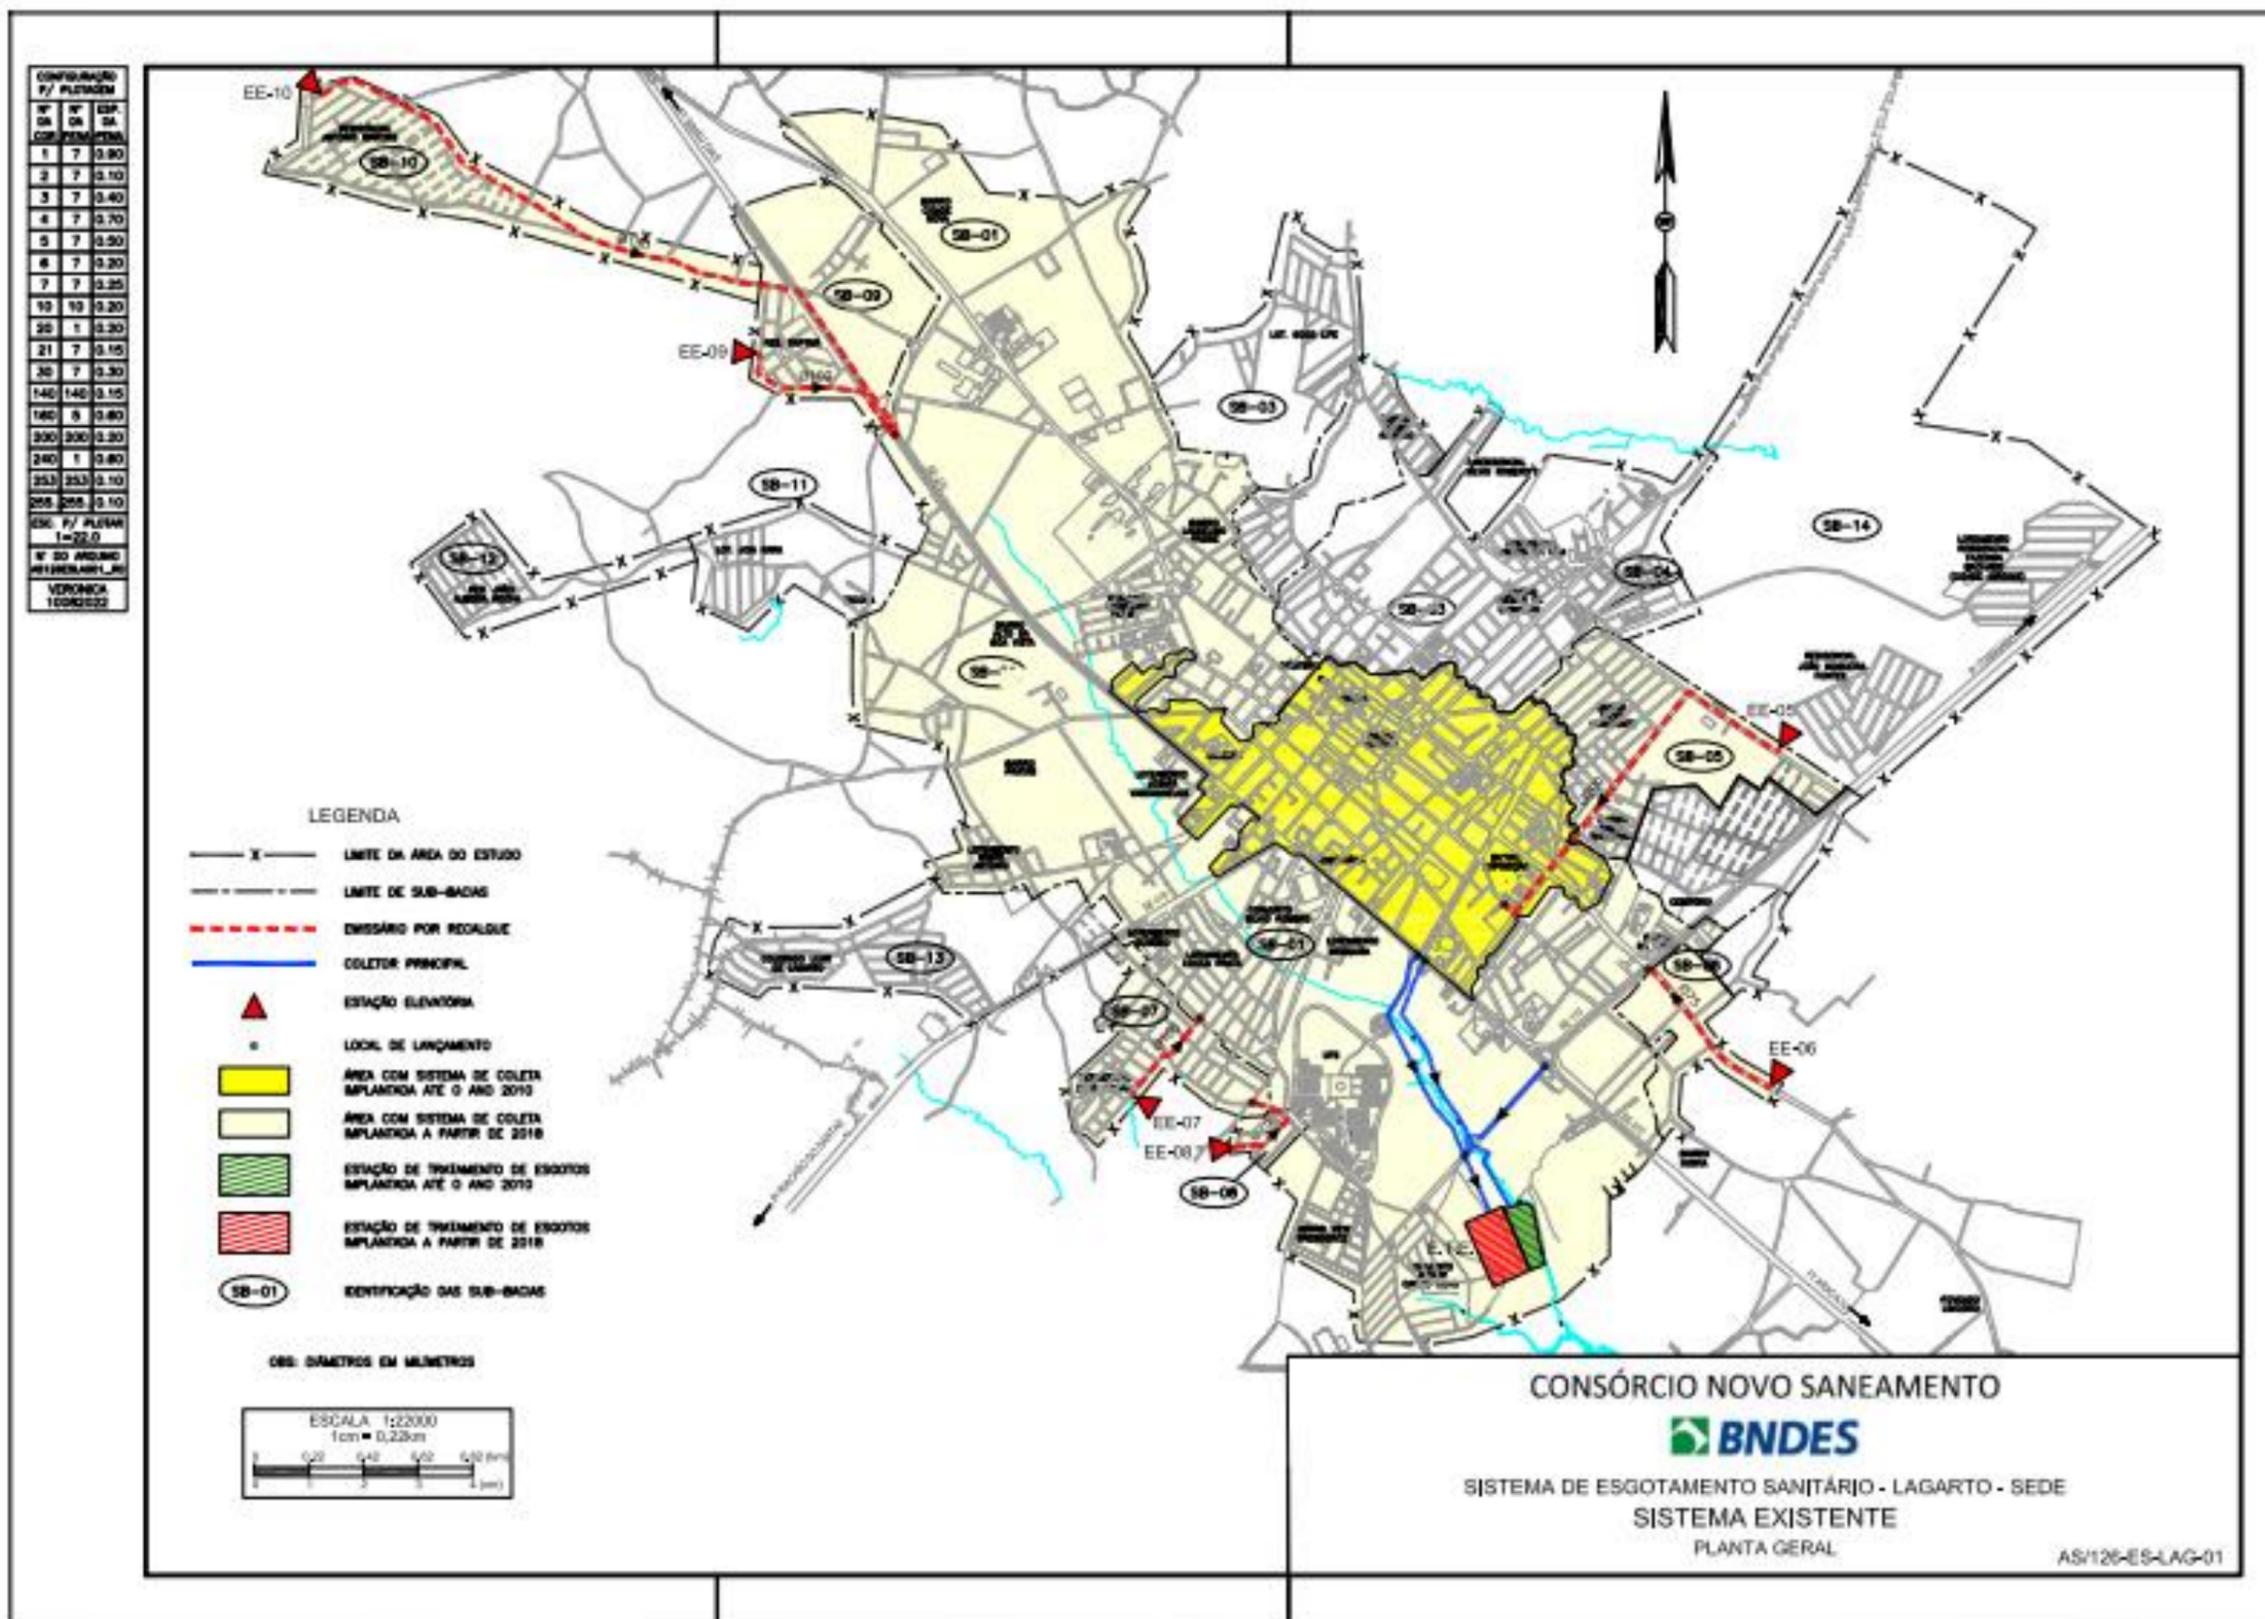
Planta do Sistema de Esgotamento Sanitário – LAGARTO
